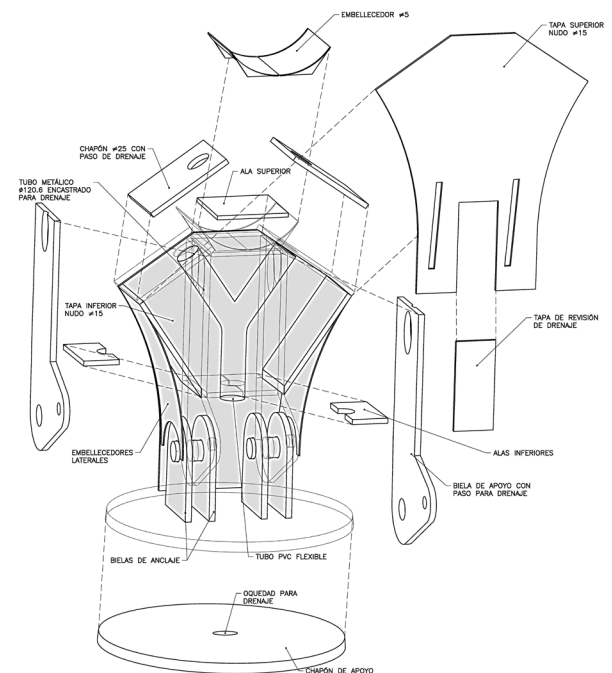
Sistema de drenaje integrado en el sistema de apoyo de rótula de apoyo de metálica.
